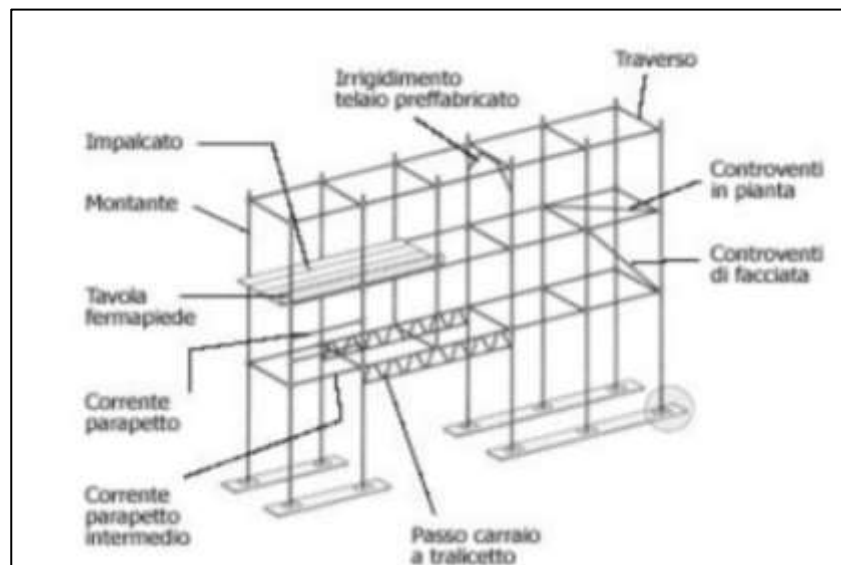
Stralcio di ponteggi utilizzati in cantiere
